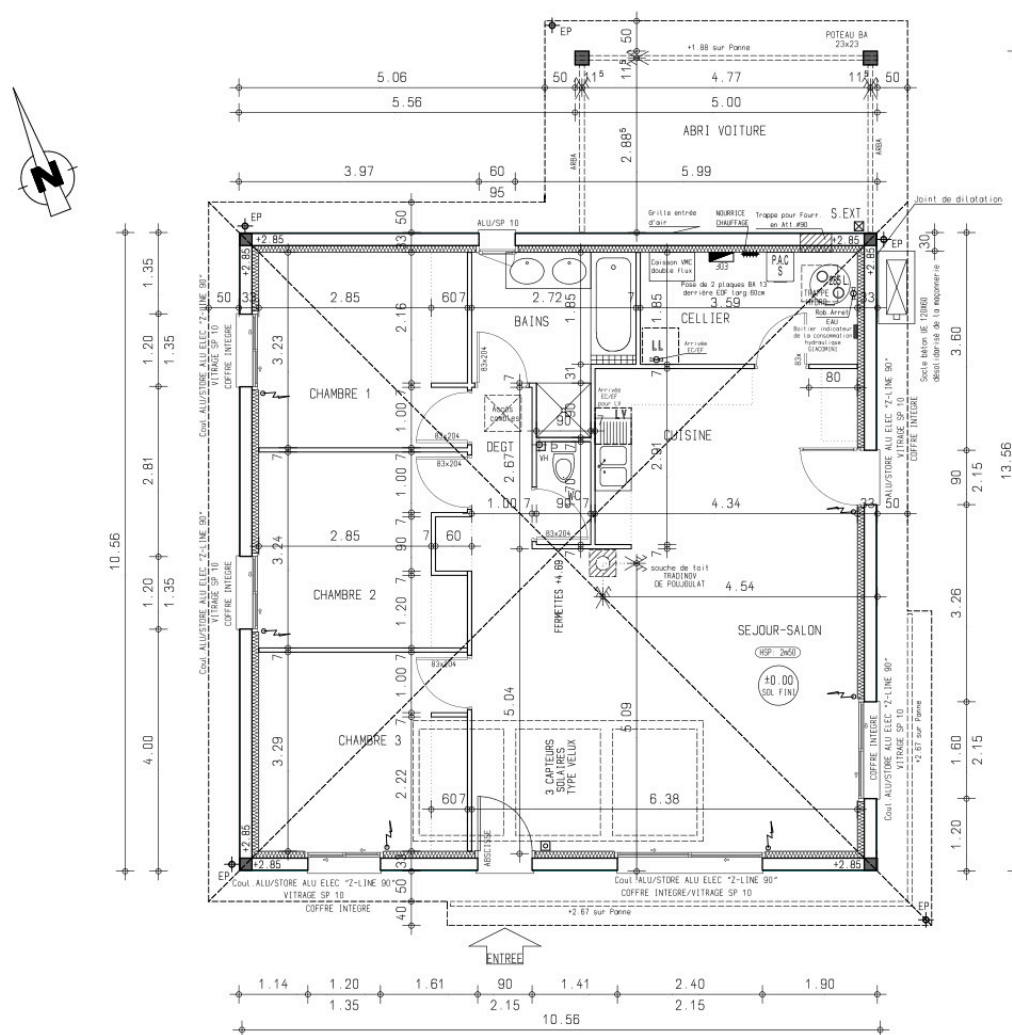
Plan du bâtiment utilisé à travers ces travaux.
